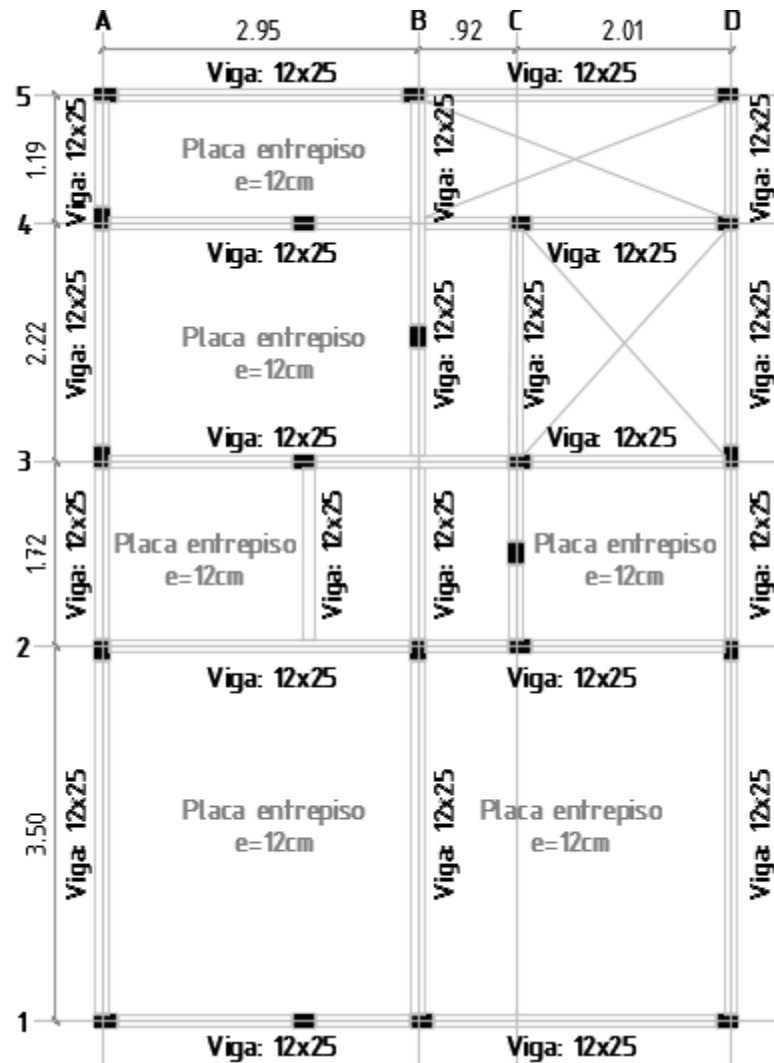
Configuración en planta de vigas de amarre a nivel de entrepiso
